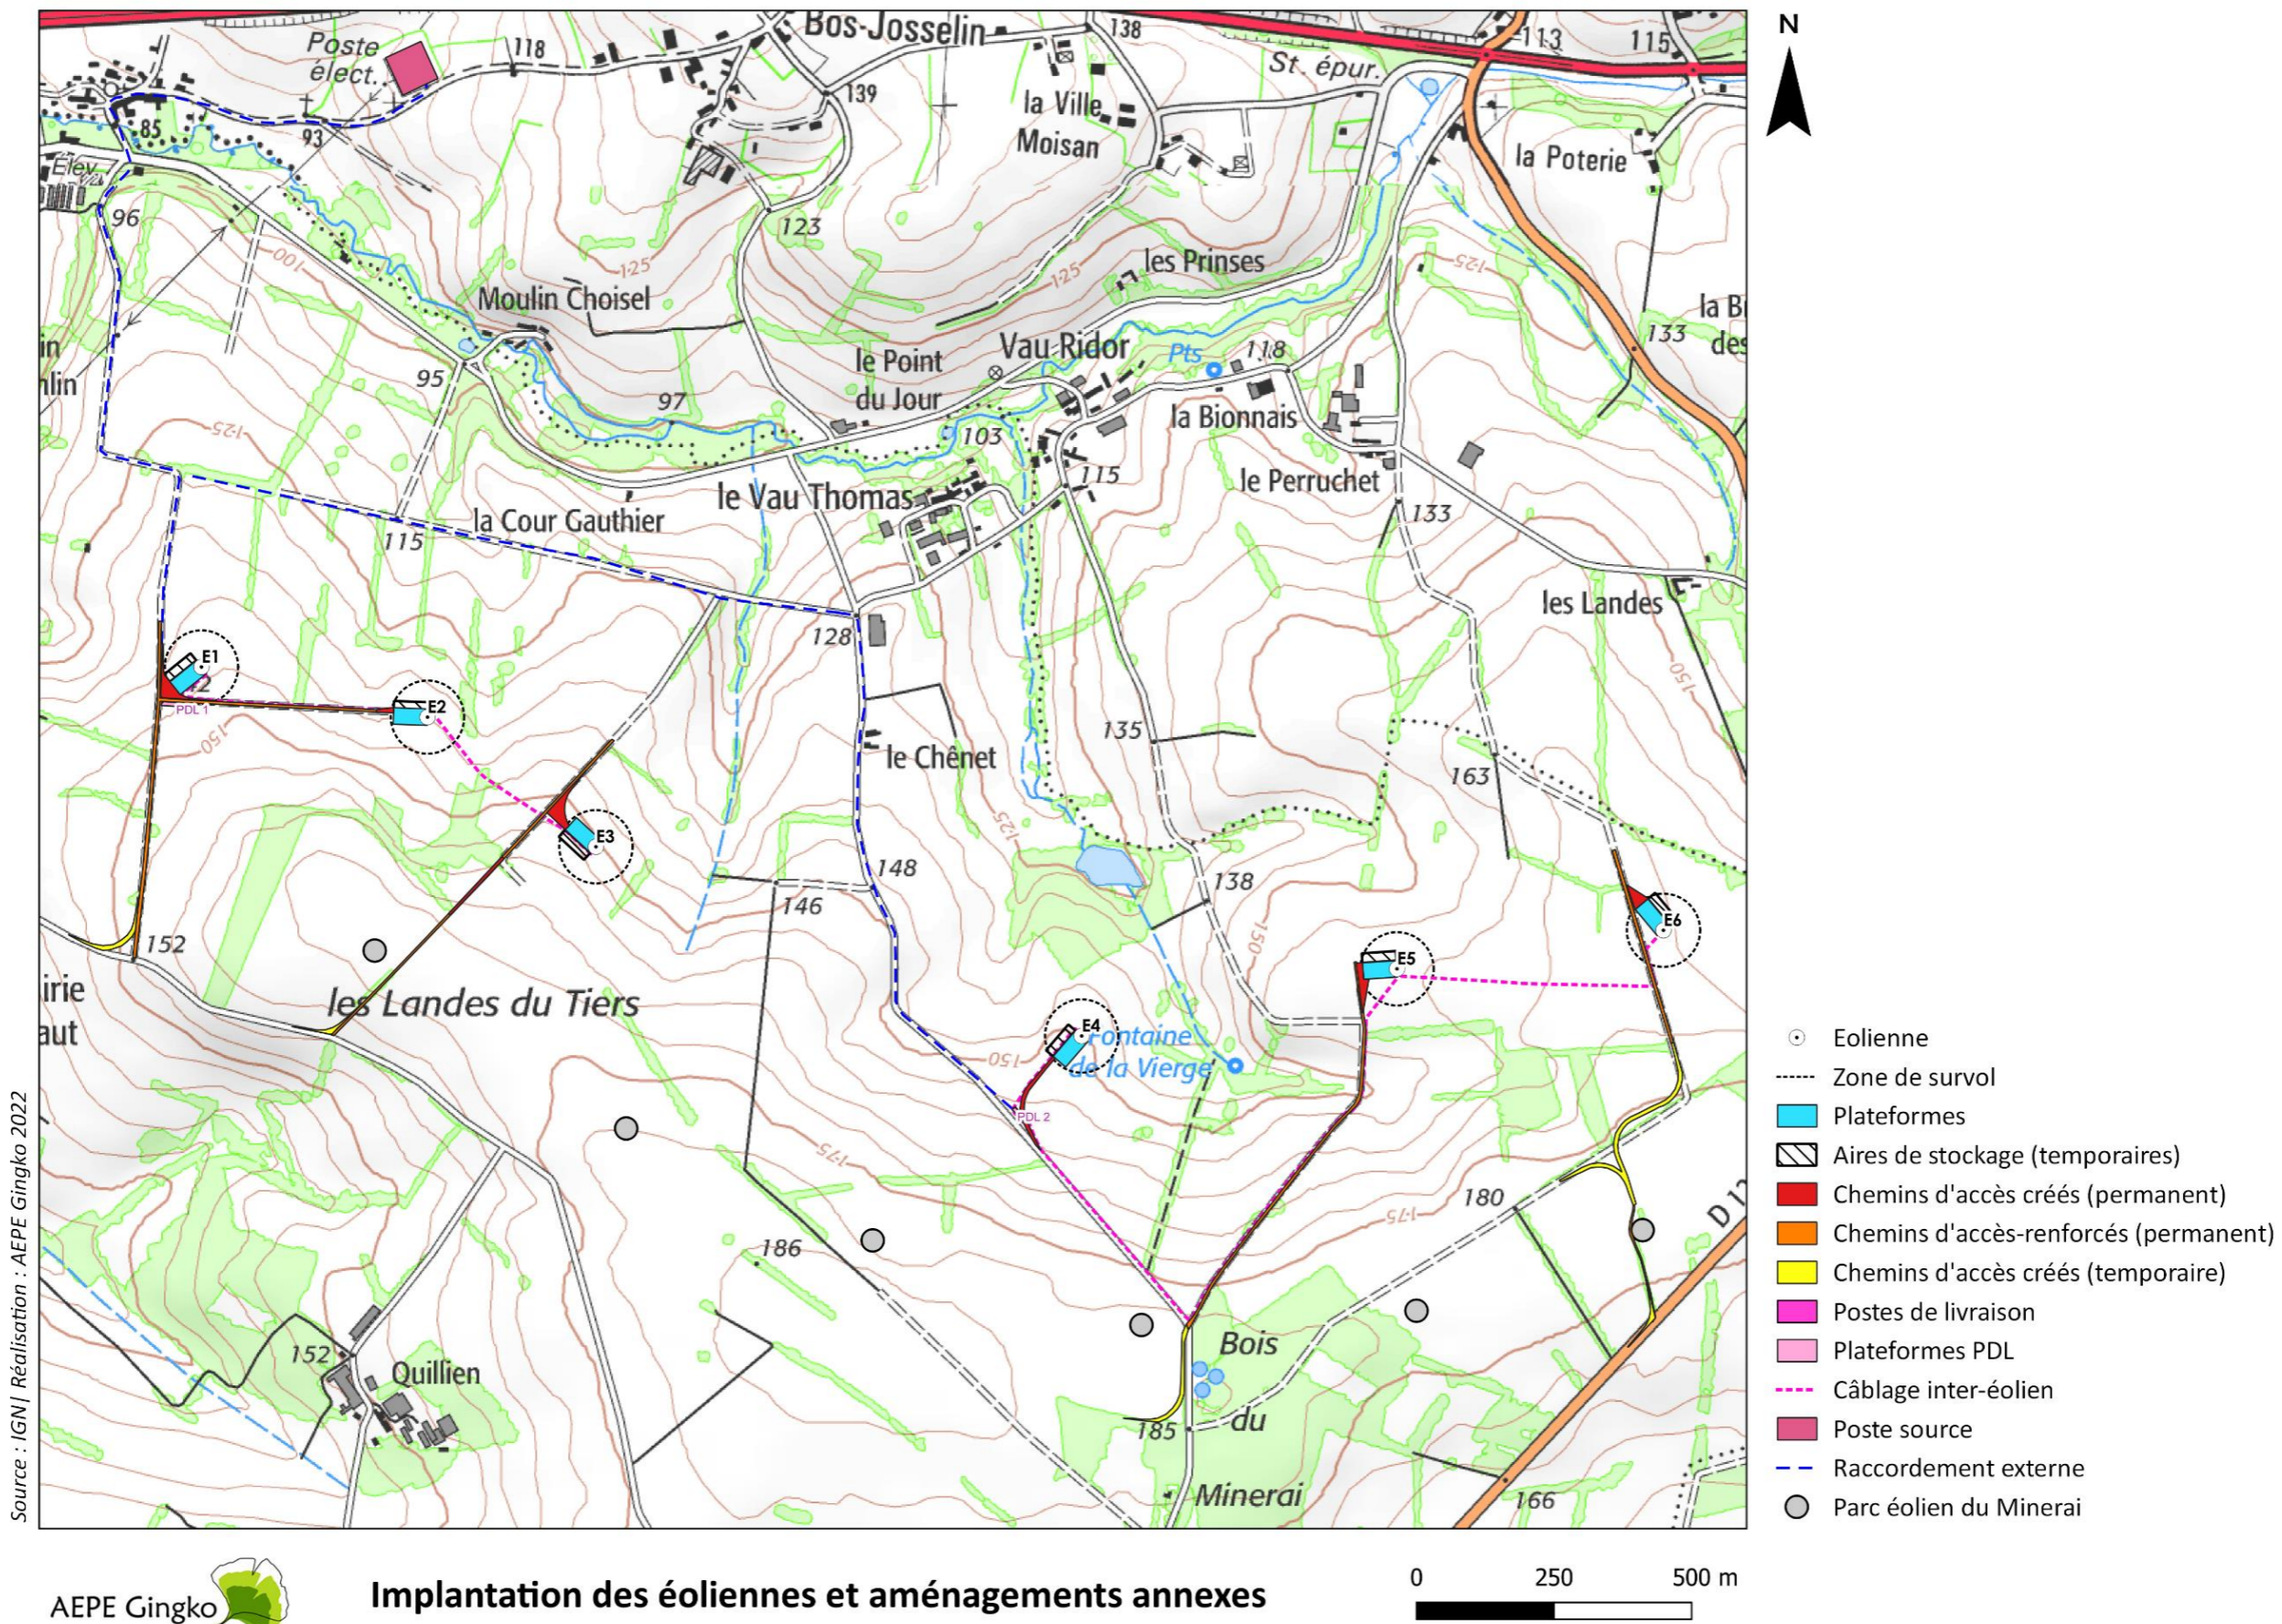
le plan général d'implantation des éoliennes et des installations annexes
